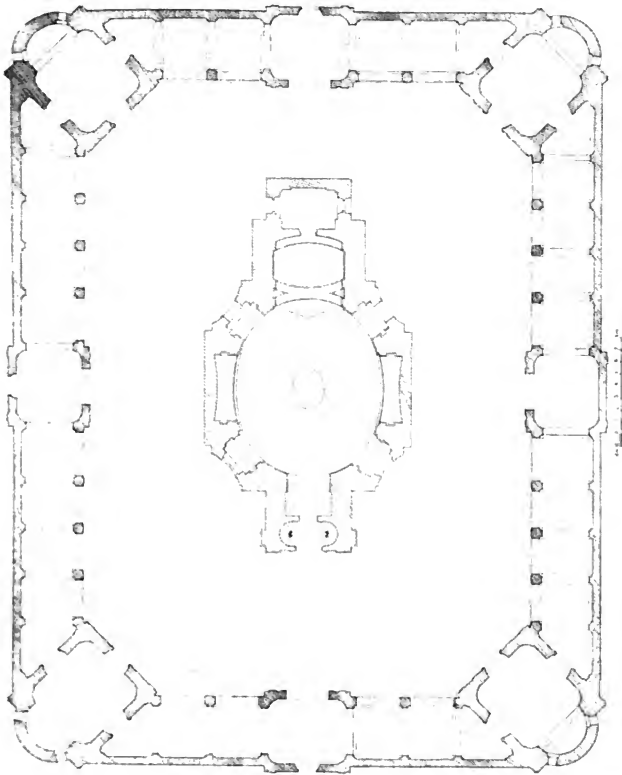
Sepekau. Marienkirche. Grundriss.
